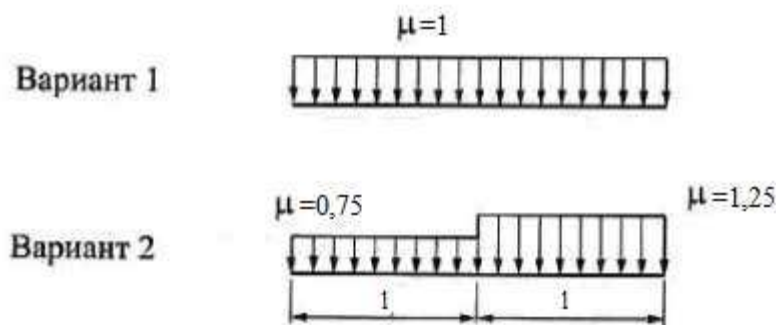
Варианты схем приложения снеговой нагрузки на двускатную кровлю
